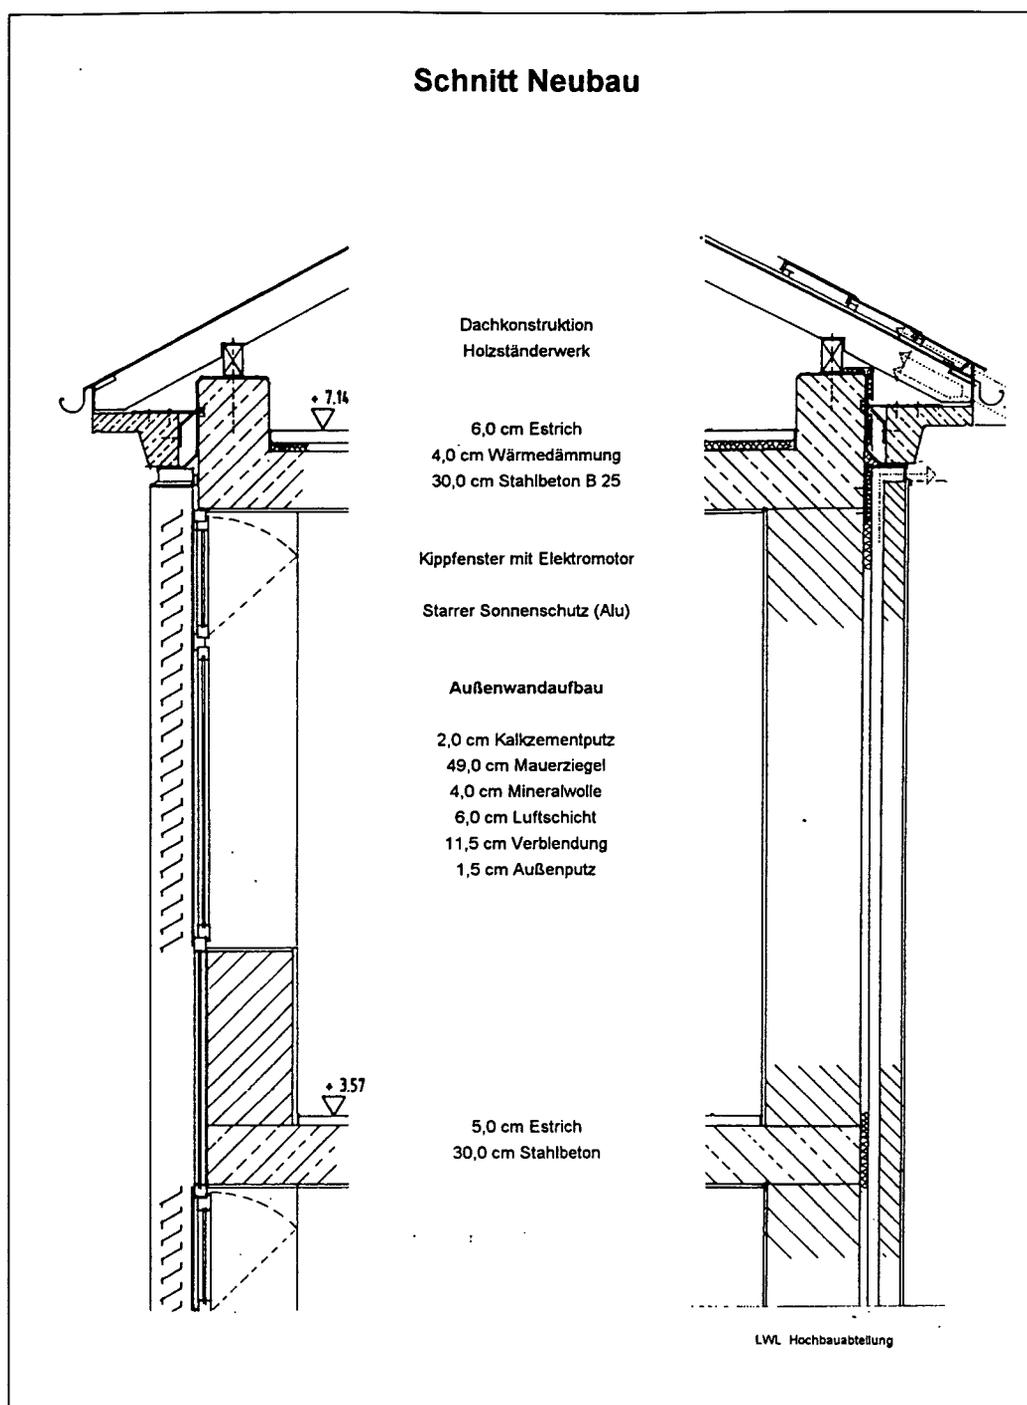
Neubau Westfälisches Archivamt - Wand- und Dachaufbau des Magazintraktes
